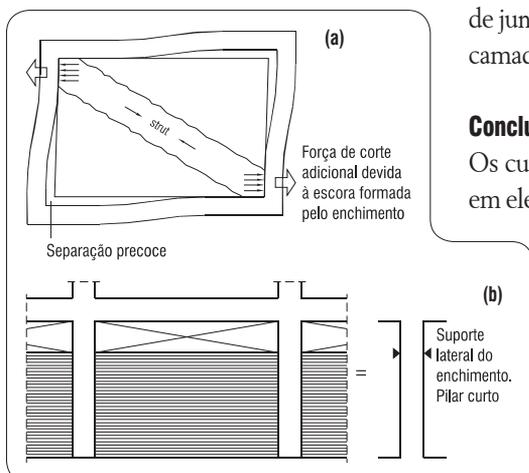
Efeitos adversos locais da interacção pórtico-enchimento: (a) força adicional nos pilares; (b) pilar curto e muito sensível ao corte devido a aberturas longas
